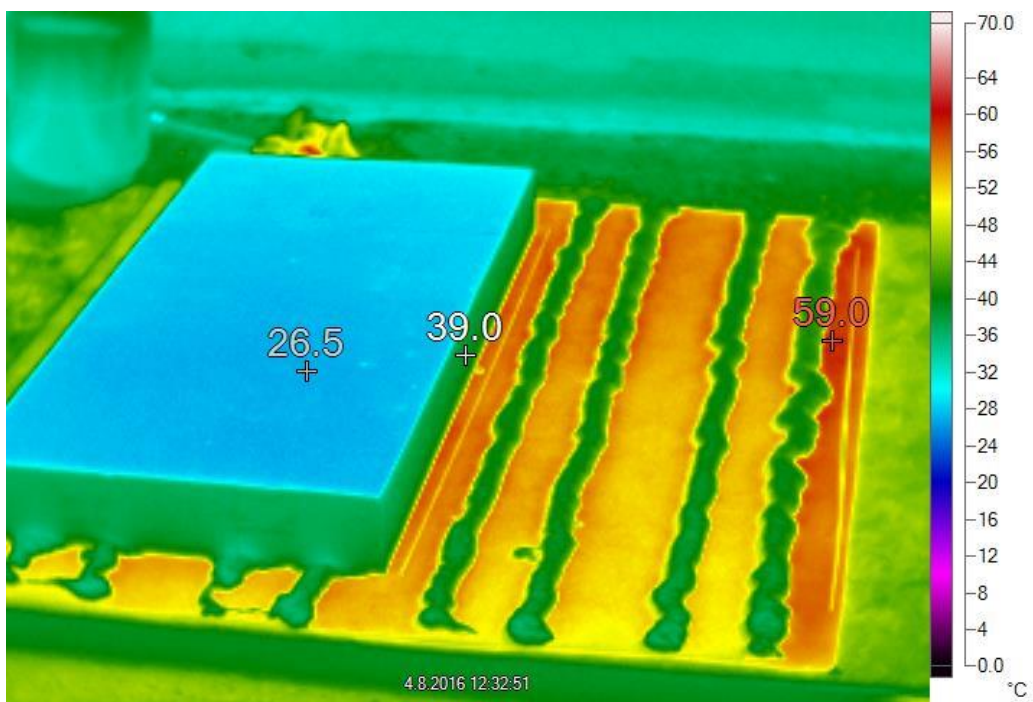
IR snímek podkladní vrstvy před lepením, 40°C
